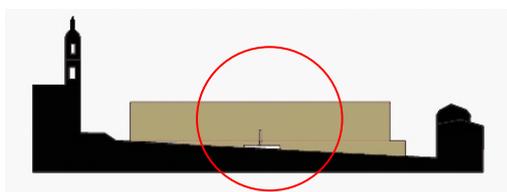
Plaza de Bolívar. Sección y planta donde se localiza el Capitolio Nacional (autor).
